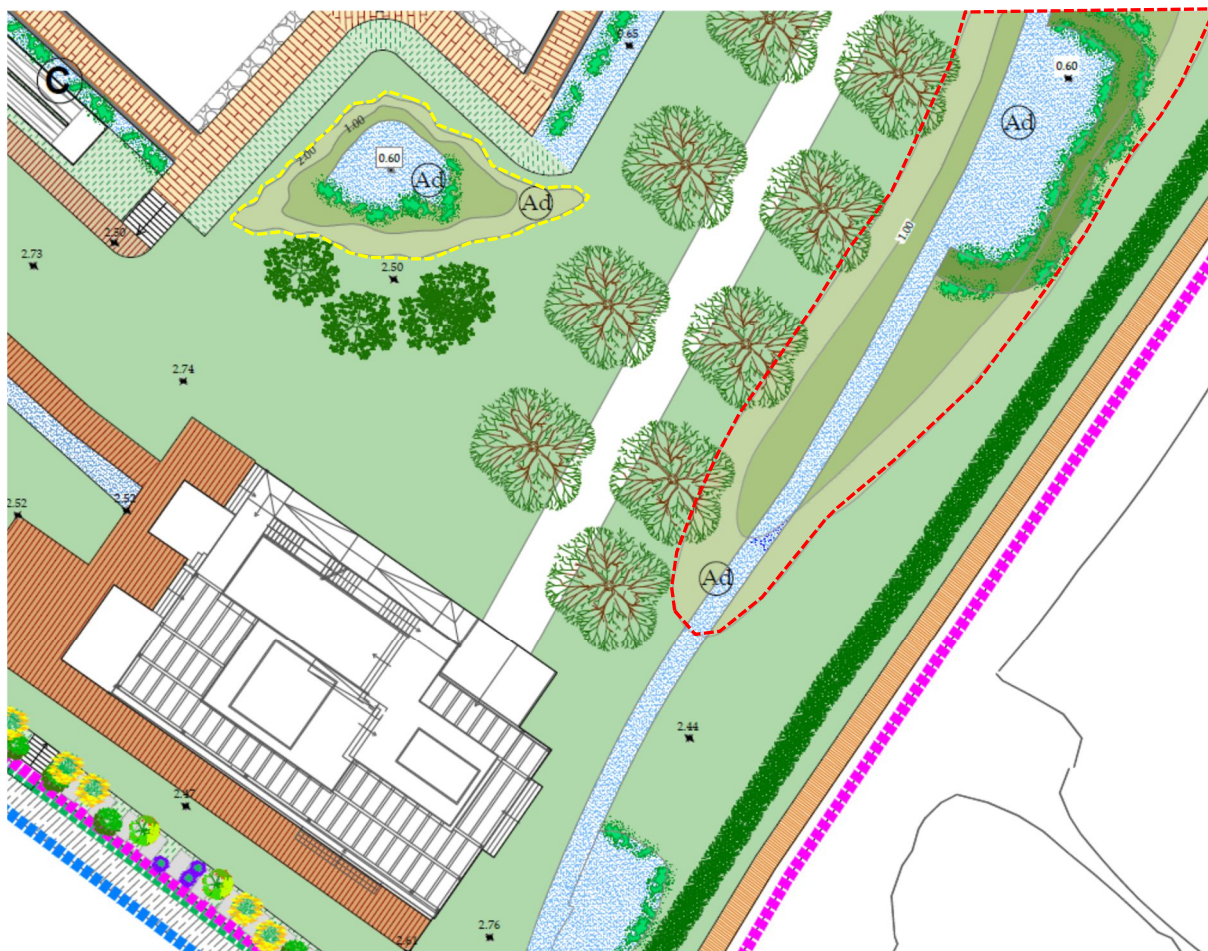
Vista di dettaglio: in rosso la perimetrazione dell'area "bird garden" originariamente prevista in progetto e in giallo quella dell'area "bird garden" di nuova introduzione
